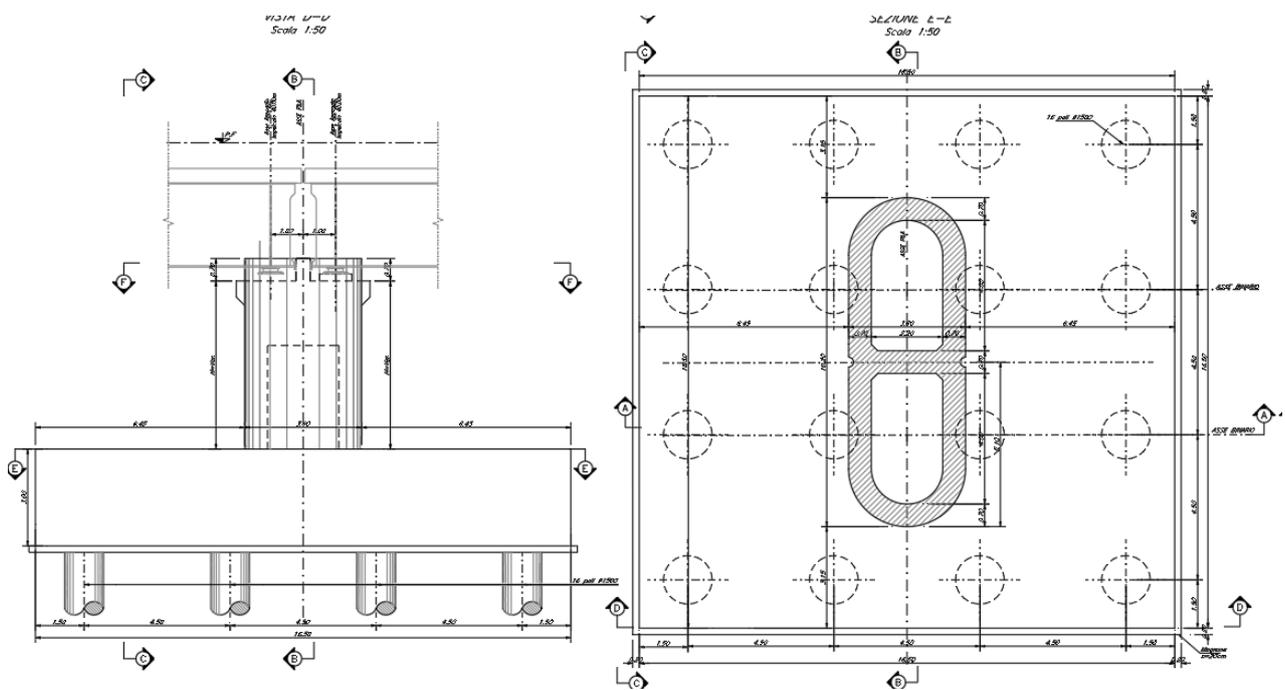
stralcio della carpenteria pila e fondazione su n°16 pali
